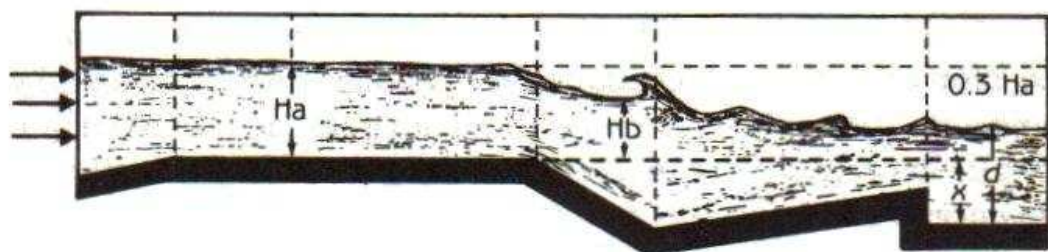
Sección de una canaleta Parshall, ilustrando la determinación de la adecuada elevación de cresta.
